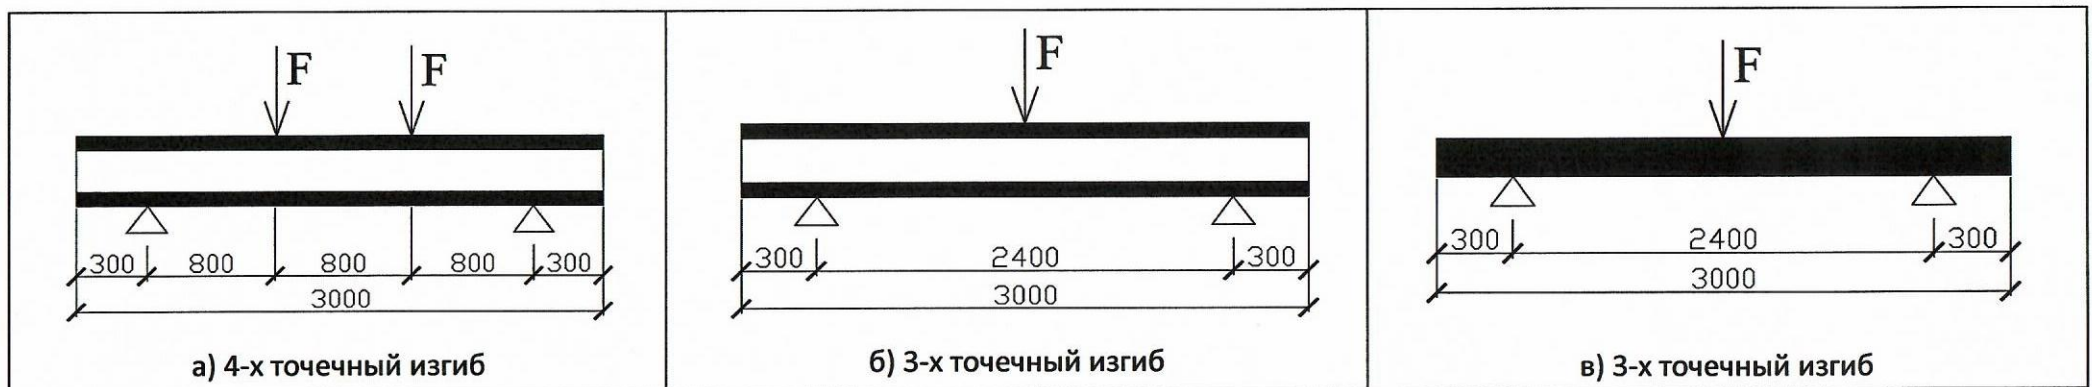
Схемы нагружения образцов балок деревянных клееных двутавровых для опалубки несущих монолитных бетонных и железобетонных конструкций: а) двумя сосредоточенными силами; б) одной сосредоточенной силой; в) одной сосредоточенной боковой нагрузкой
